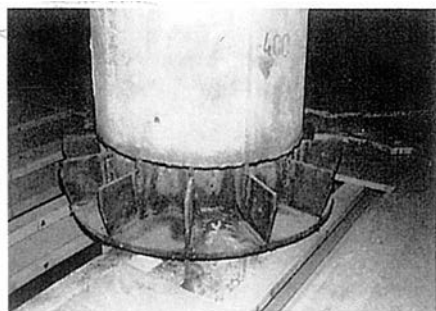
Устройство воротника свариваемого с арматурой сваи-колонны или закладными деталями.
